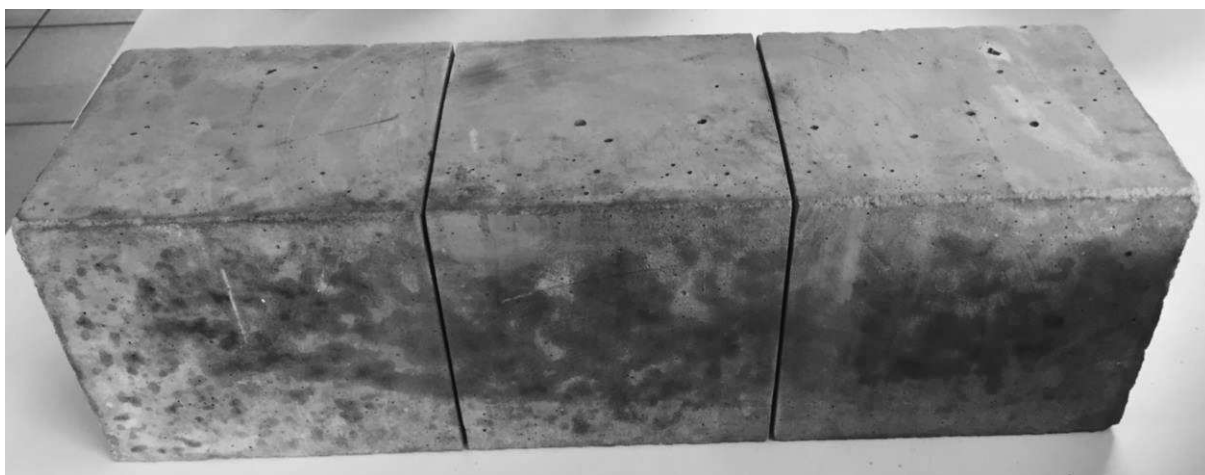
Corpo de prova prismático com 2 planos de cisalhamento.
